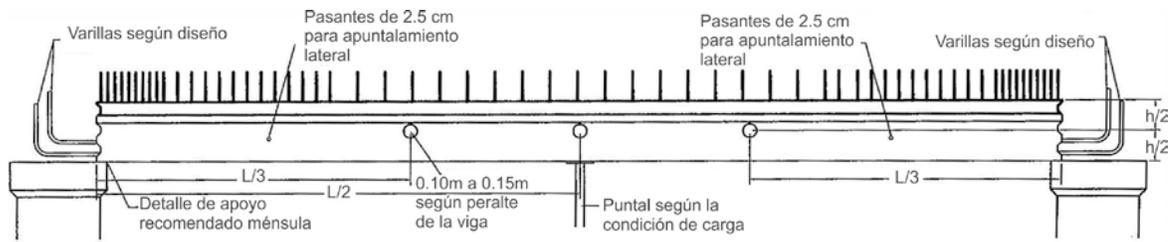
Vista longitudinal de viga de carga, ubicación estándar de pasantes
